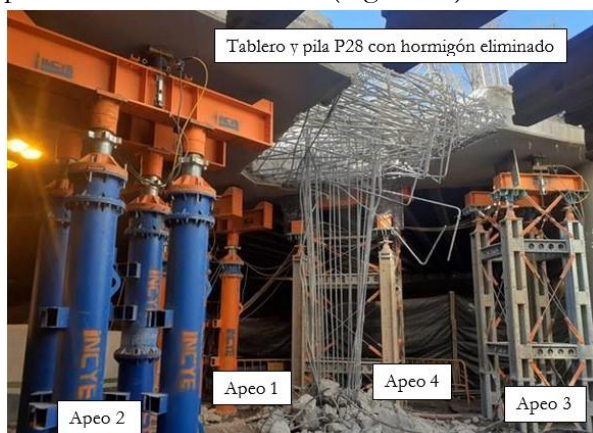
Losa sobre apeos y demoliciones de pila y tablero completadas
